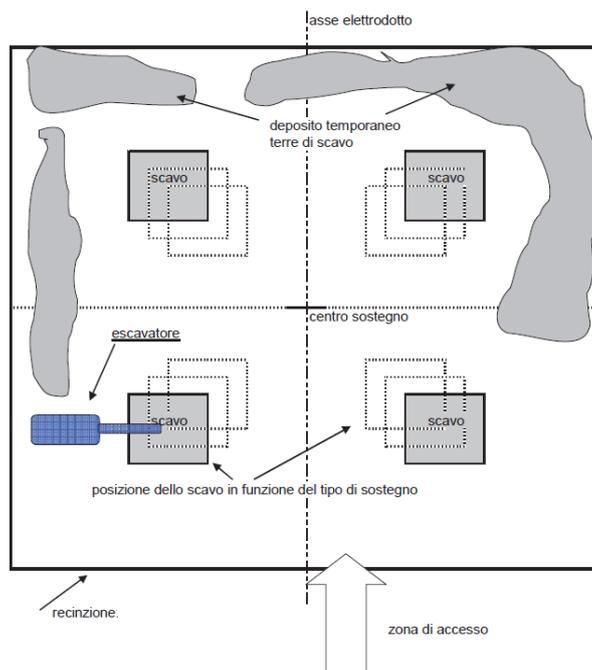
Planimetria tipologia del microcantiere nella fase di scavo delle fondazioni
